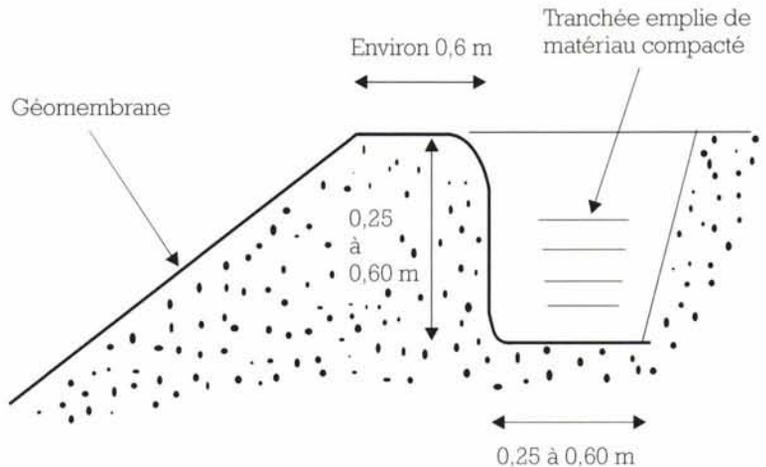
Principe de l'ancrage en tête d'une géomembrane. (d'après « Etanchéité des barrages par géomembranes : technique actuelle » - Bulletin n°78 de la C.I.G.B. - 140 pp -1991 - [56]).
